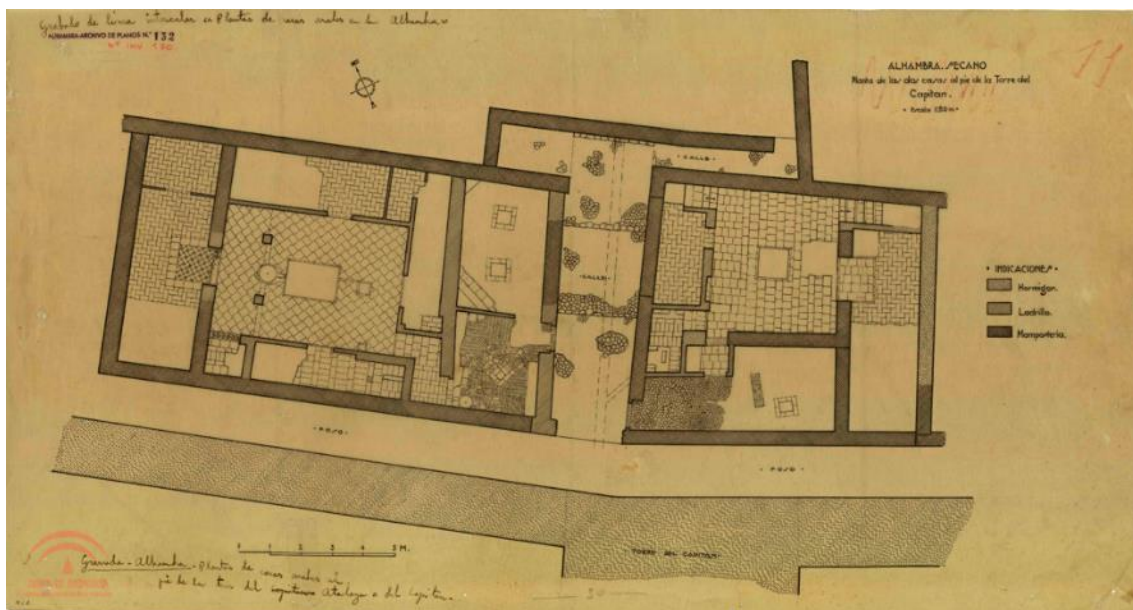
Plano de las casas junto a la Torre del Capitán.
